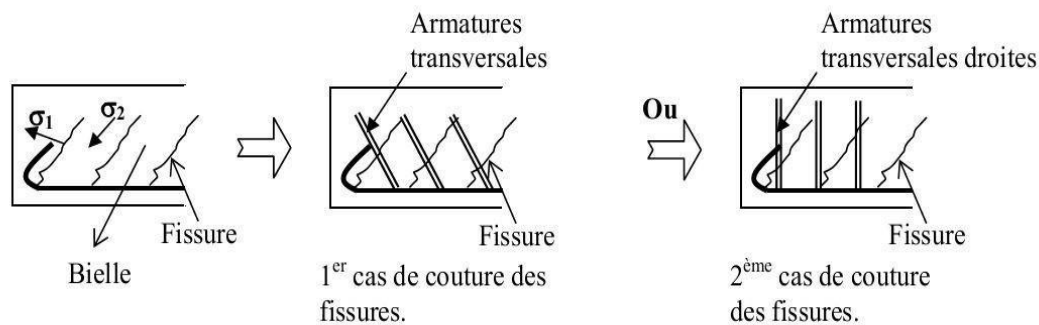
Position des armatures transversales et l'angle d'inclinaison des fissures dans une poutre droite.
